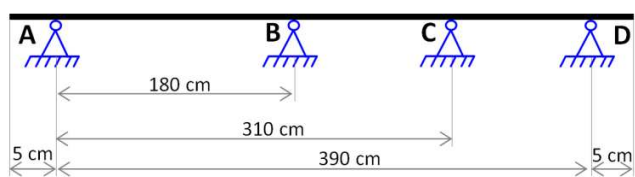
Distancia entre apoyos para el caso de tres apoyos
